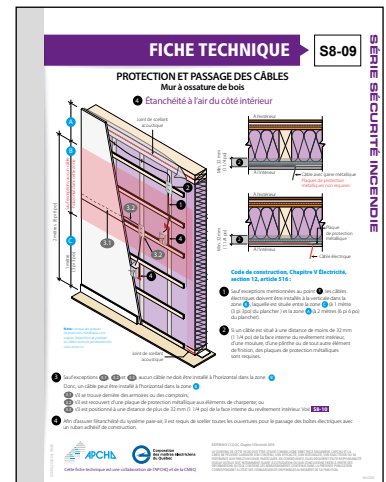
Fiche S8-10 - Protection et passage des câbles
